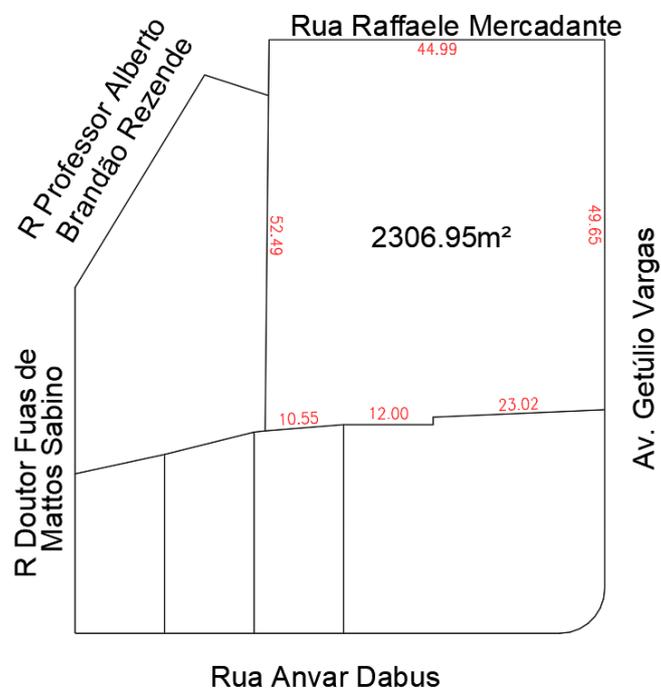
Terreno de implantação – Fonte: Elaboração própria
